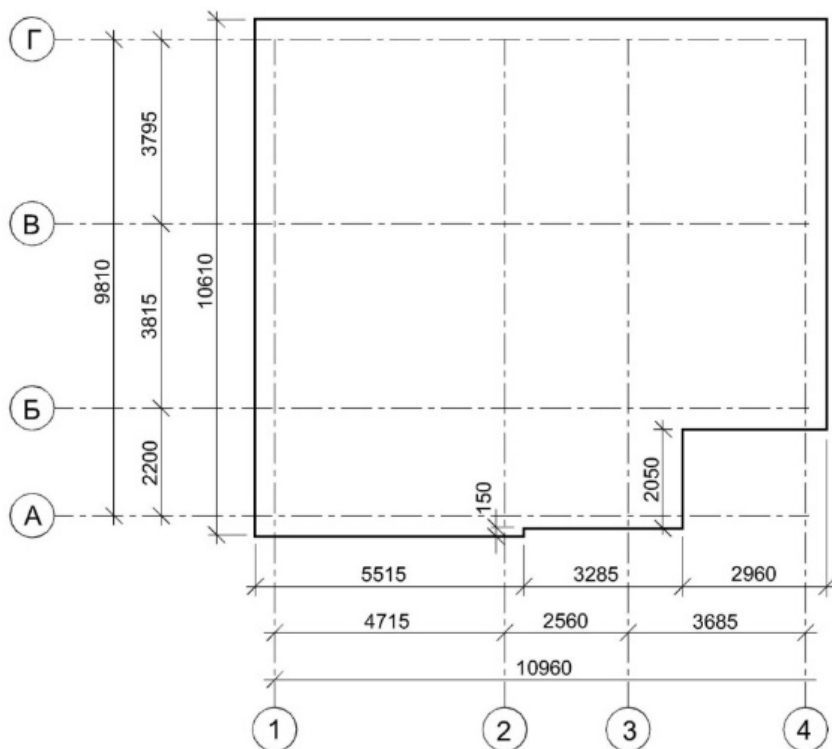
План плиты перекрытия на отметке –0,130
